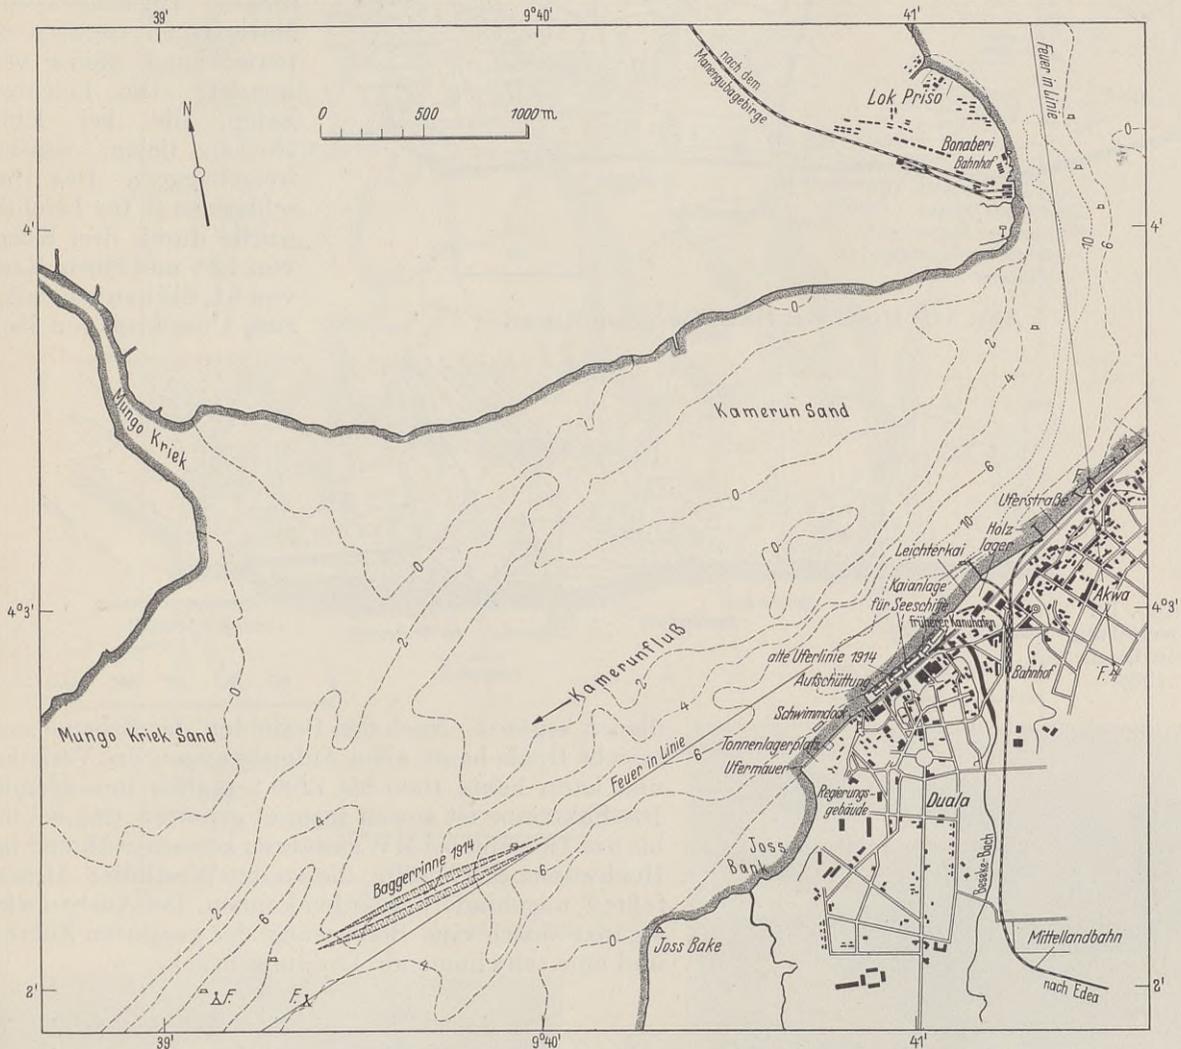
Lageplan der Innenbarre und des Flußufers bei Duala 1937.
